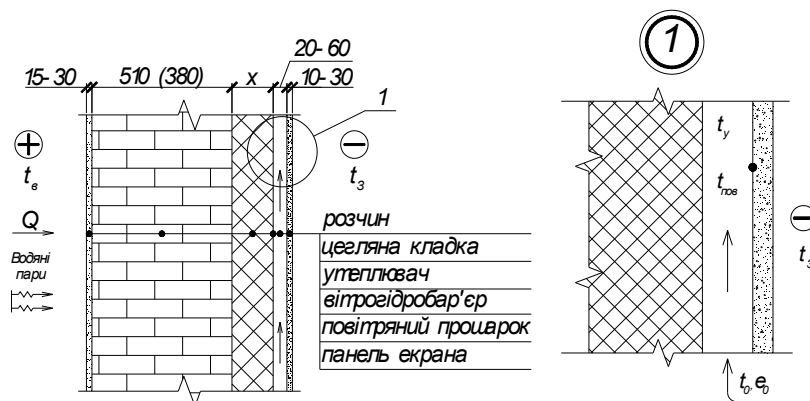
Фасадна система з вентиляваним повітряним прошарком:
